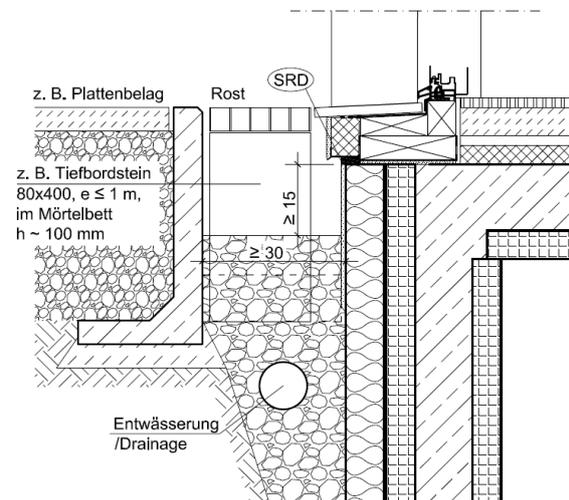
Terrasse mit Fenstertüre und Putzfassade
